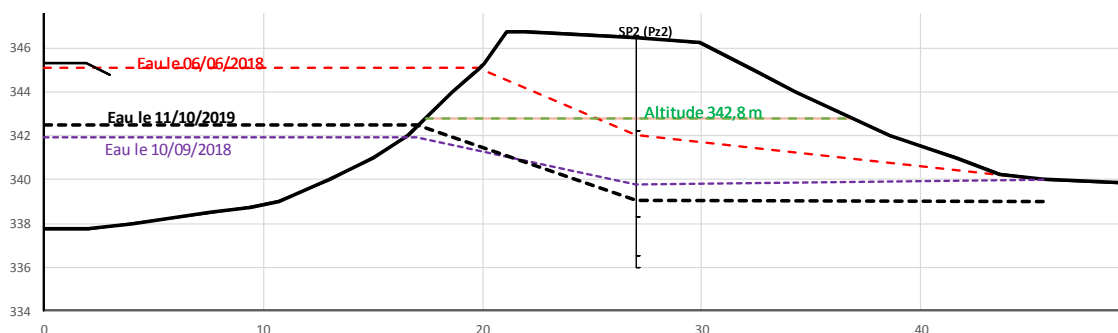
Profils piézométriques dans la digue du plan d'eau A
